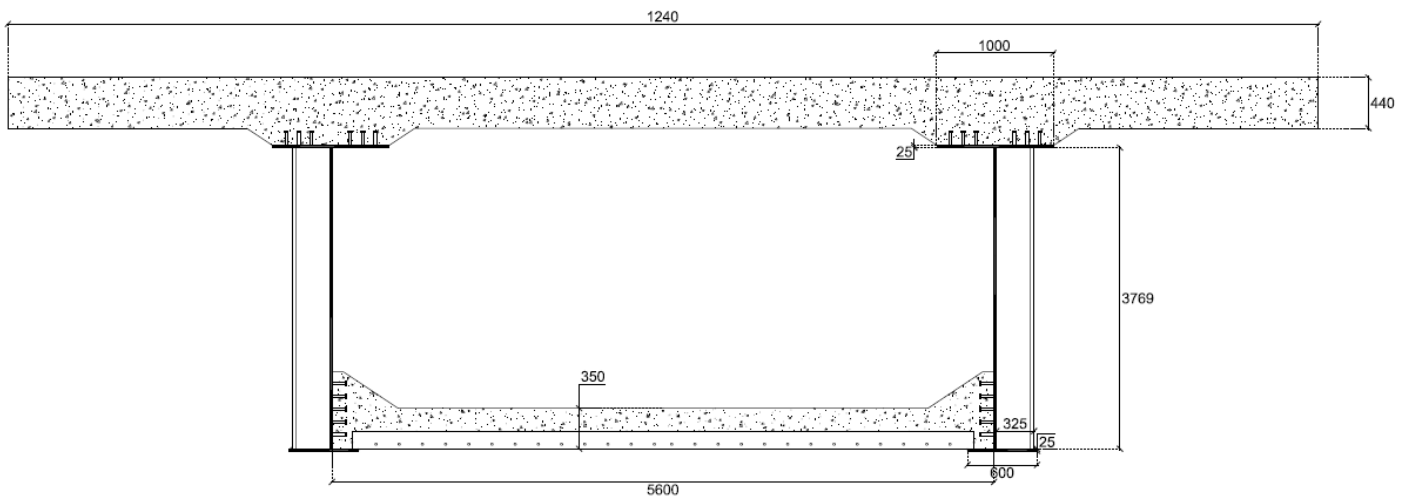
Section transversale du viaduc ferroviaire en structure SBAM
